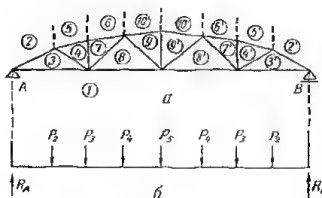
Расчетная схема фермы (а) и схема приложения нагрузок (б).
